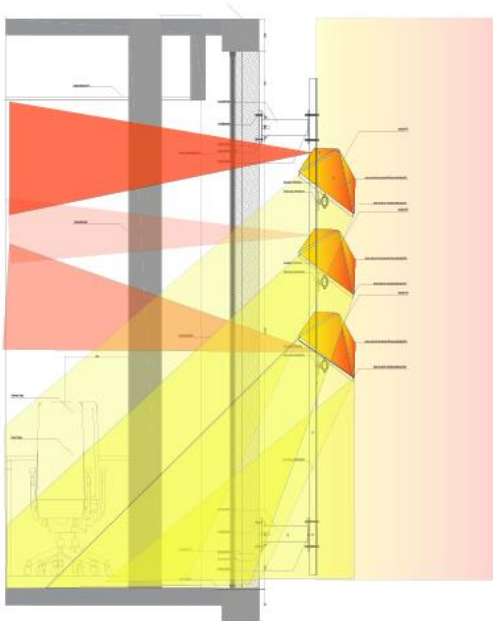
Ingreso Solar fachada calle 11A. Elaboración propia.
